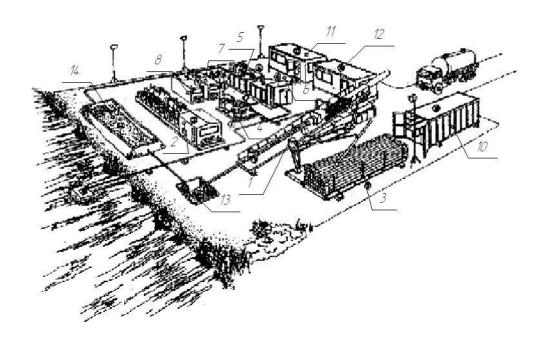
Схема размещения установки ГНБ на строительной площадке
